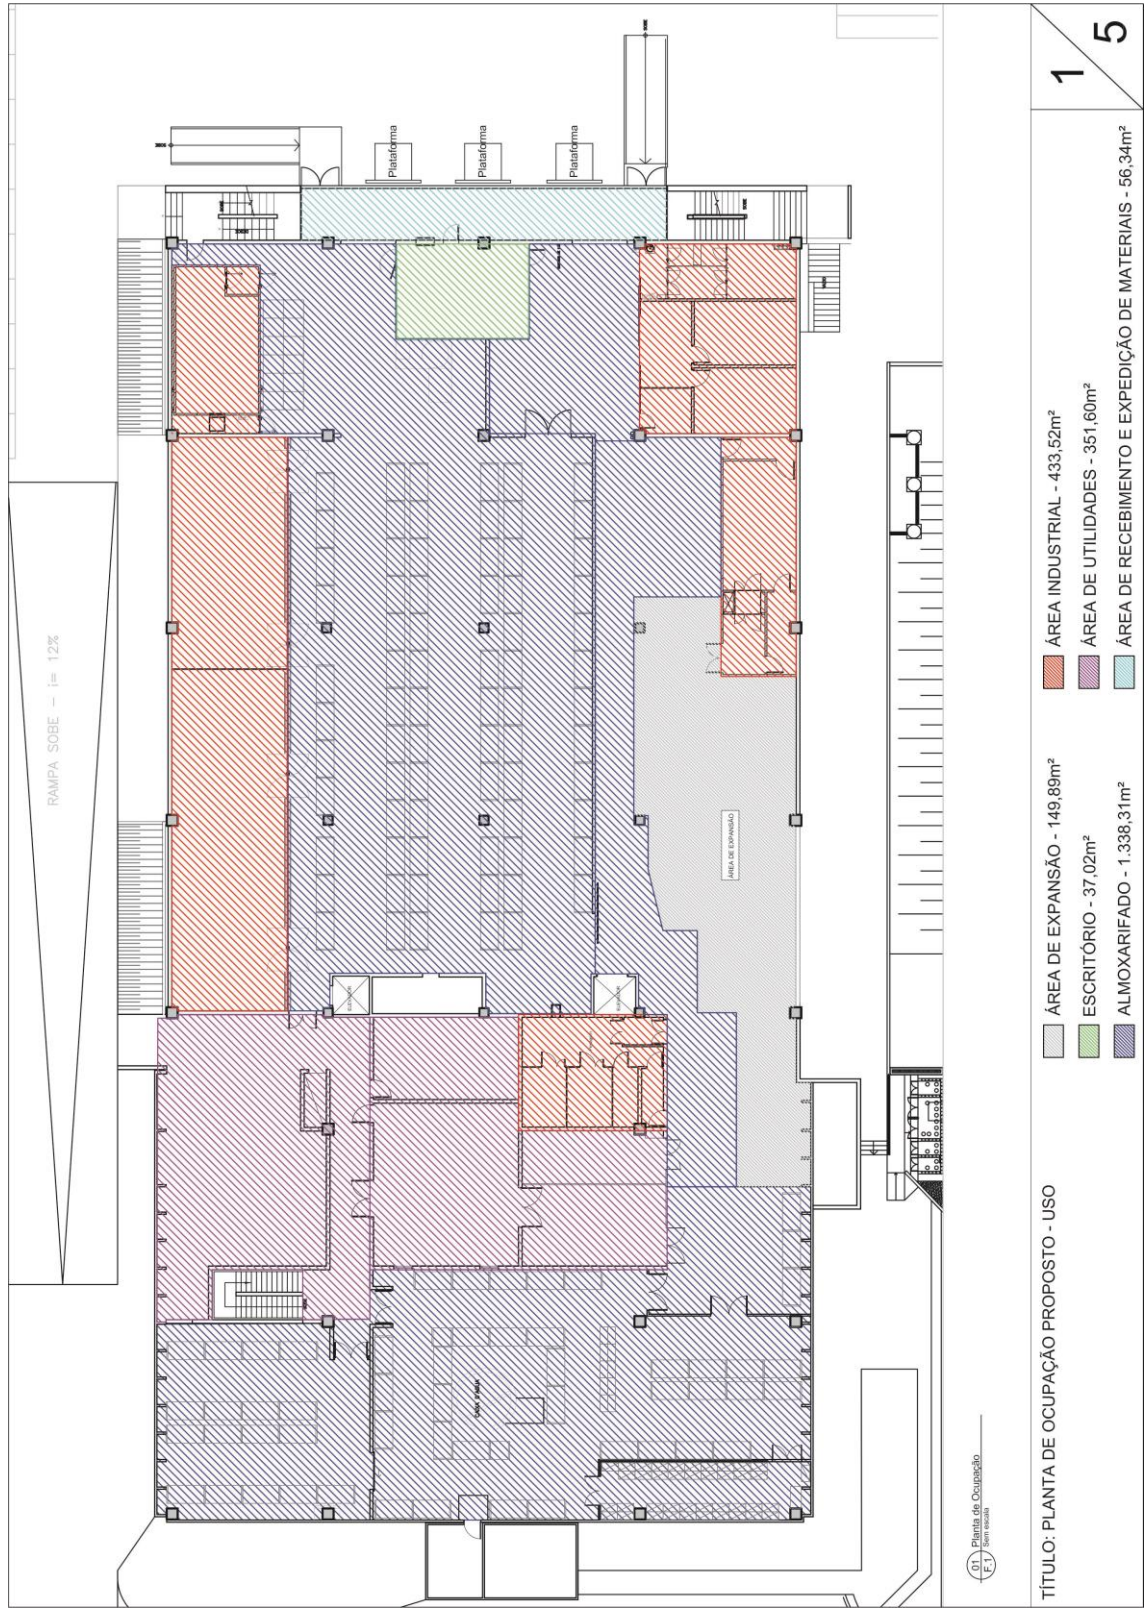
Planta de ocupação proposto - uso, São Paulo - SP.
